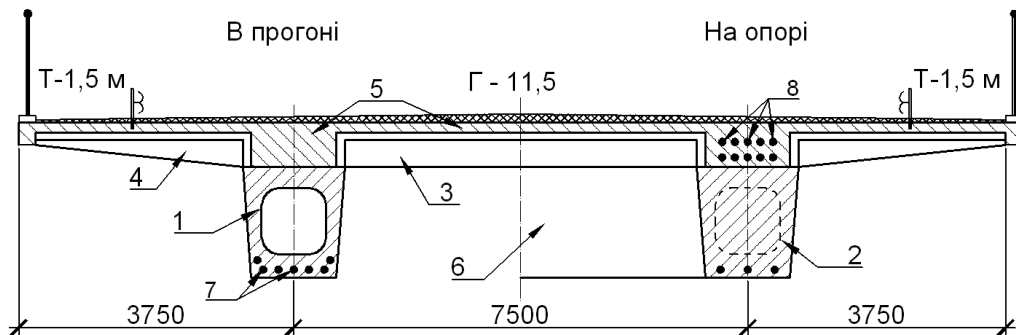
Двобалкова нерозрізна збірно-монолітна залізобетонна прогонова будова моста для складних умов будівництва: 1 - збірна прогонова балка; 2 - монолітна або збірна надопорна балка; 3 - збірна ребриста плита; 4 - збірна ребриста консольна плита; 5 - бетон замонолічування головних балок і плити; 6 - монолітна діафрагма в стиках і над опорами; 7 - напружувана арматура в прогонах збірних балок; 8 - напружувана арматура в надопорних зонах і стиках.
